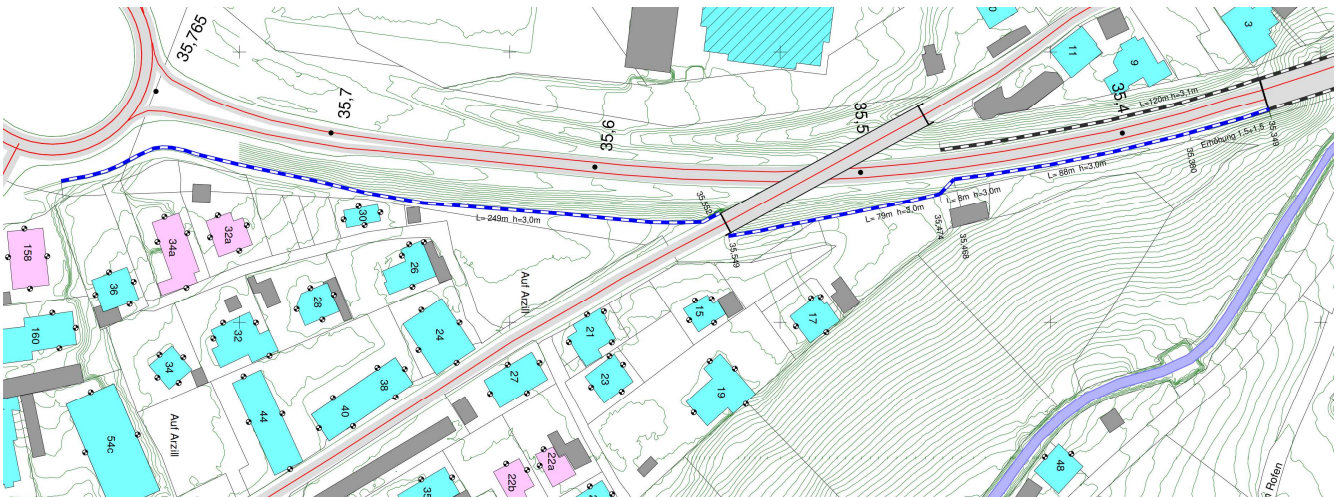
Übersichtslageplan mit baul. Schallschutz V01, Auszug aus Plan H016_12 /6/
